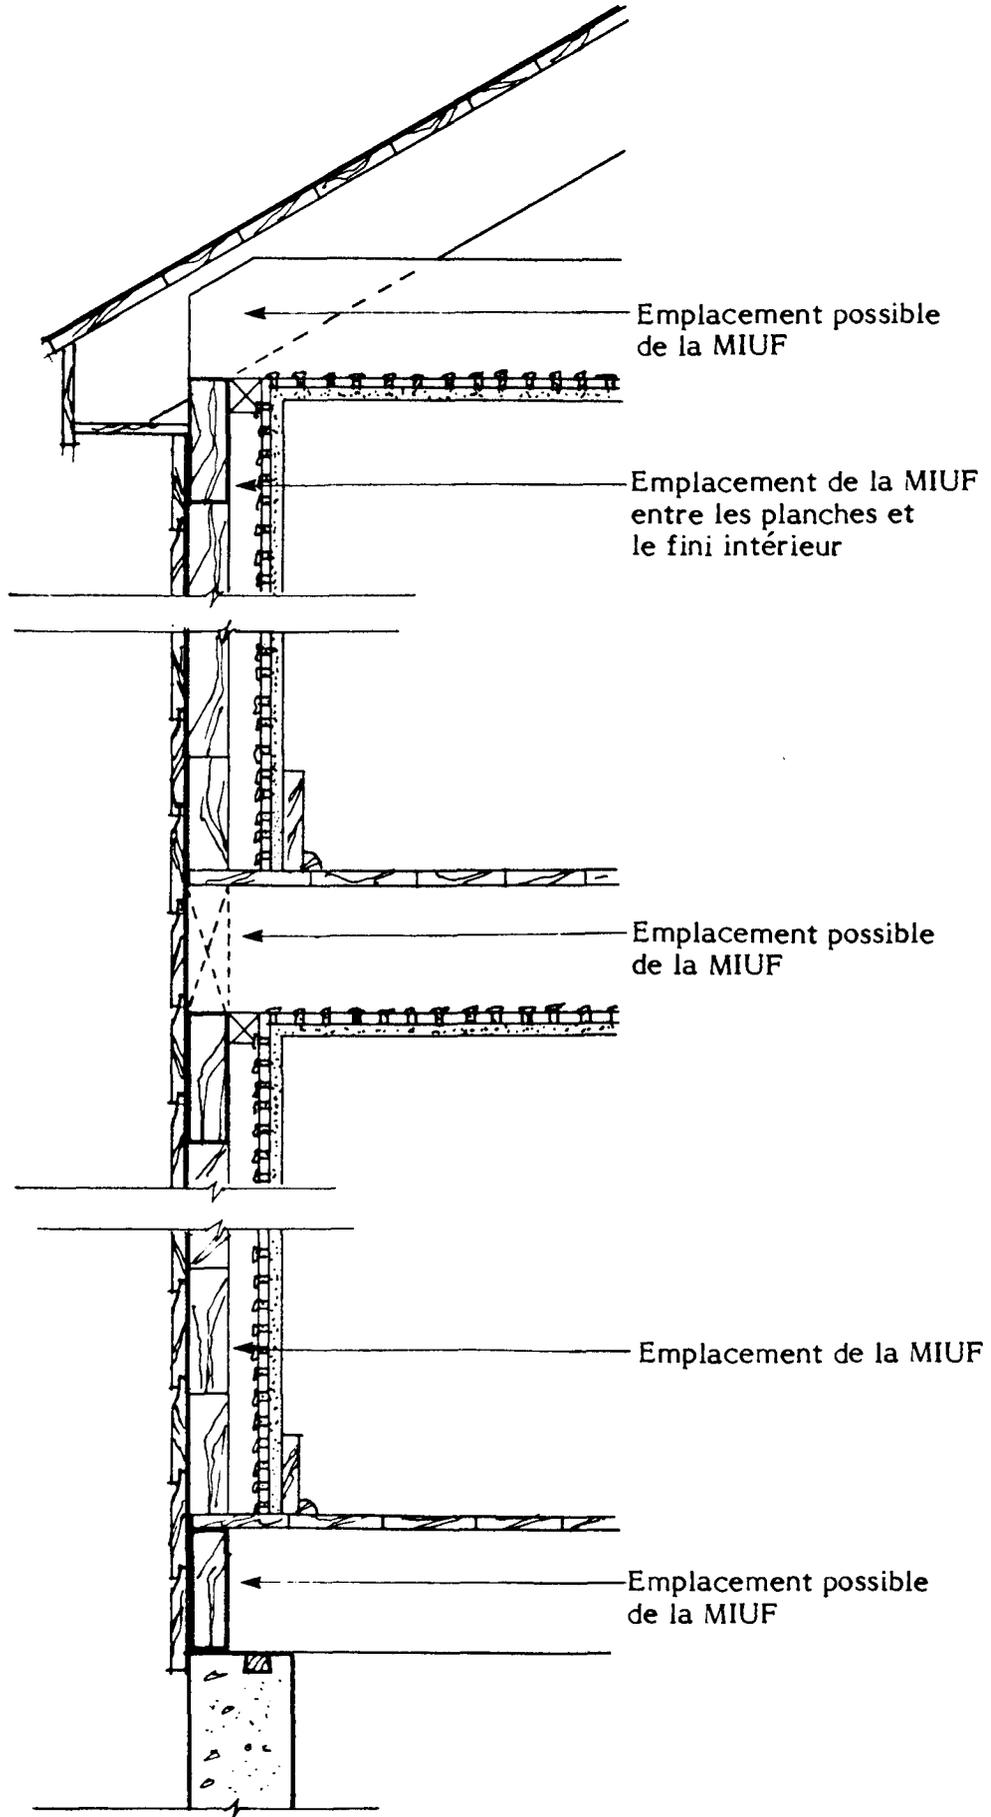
CONSTRUCTION À CHARPENTE DE MADRIERS - DÉTAILS MONTRANT
